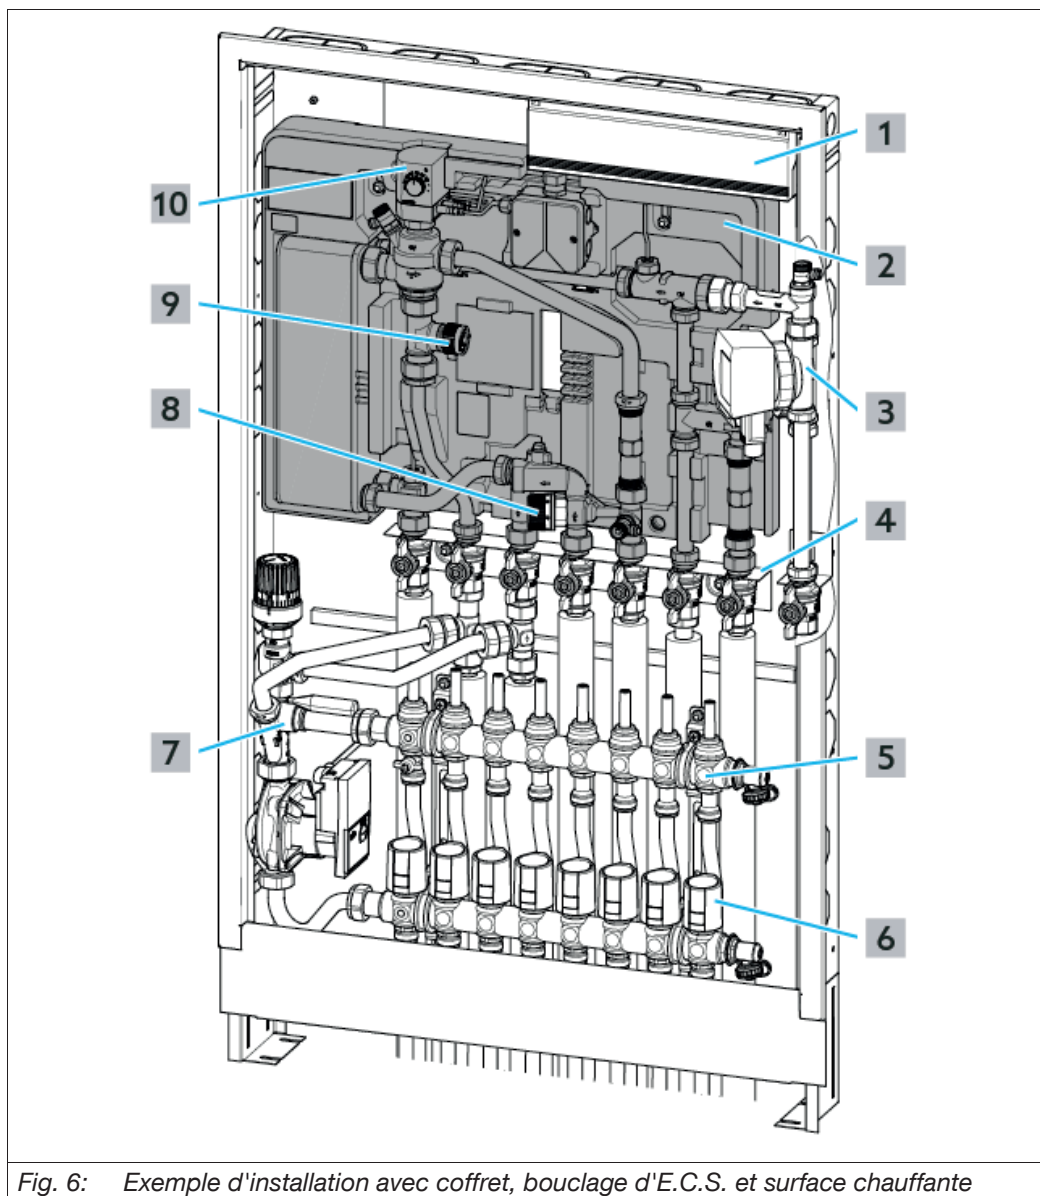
Exemple d'installation avec coffret, bouclage d'E.C.S. et surface chauffante
